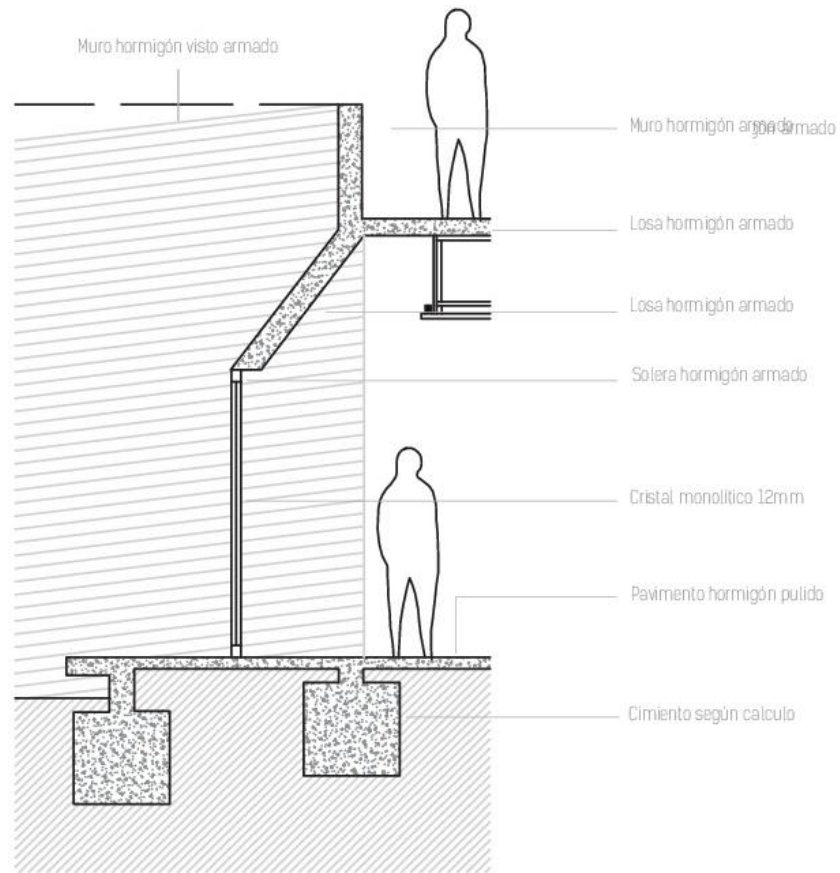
Detalle constructivo museo de Atacama. Ilustración autor
